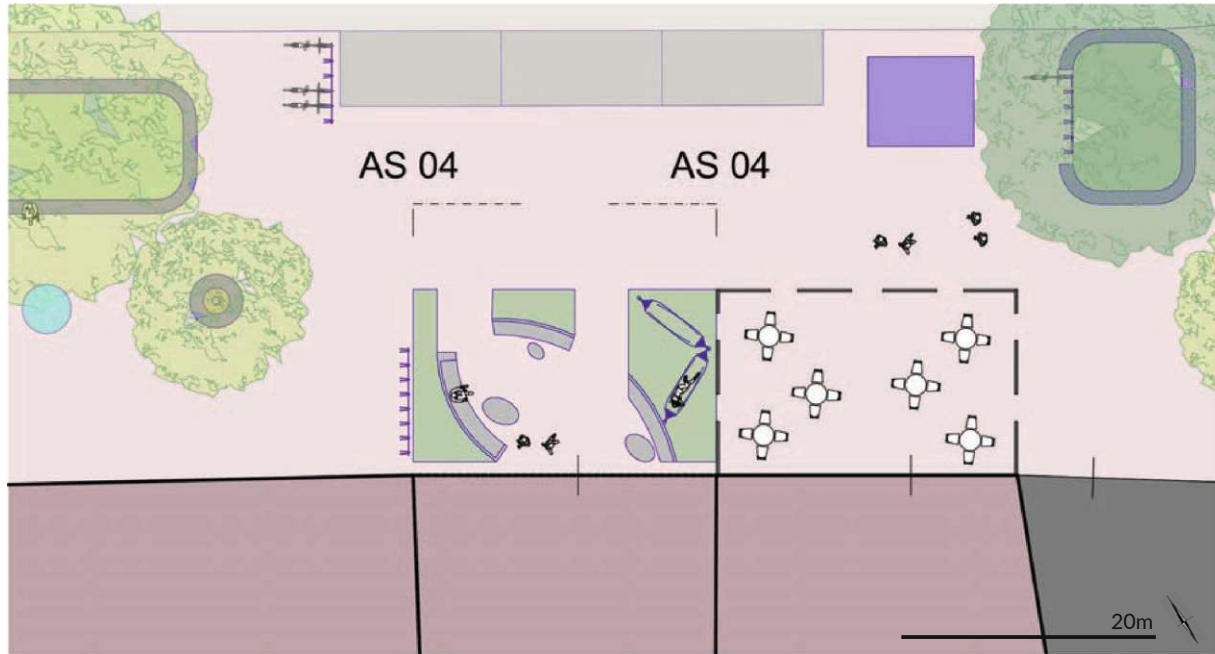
Grundrissausschnitt Bibliothek, eigene Darstellung
